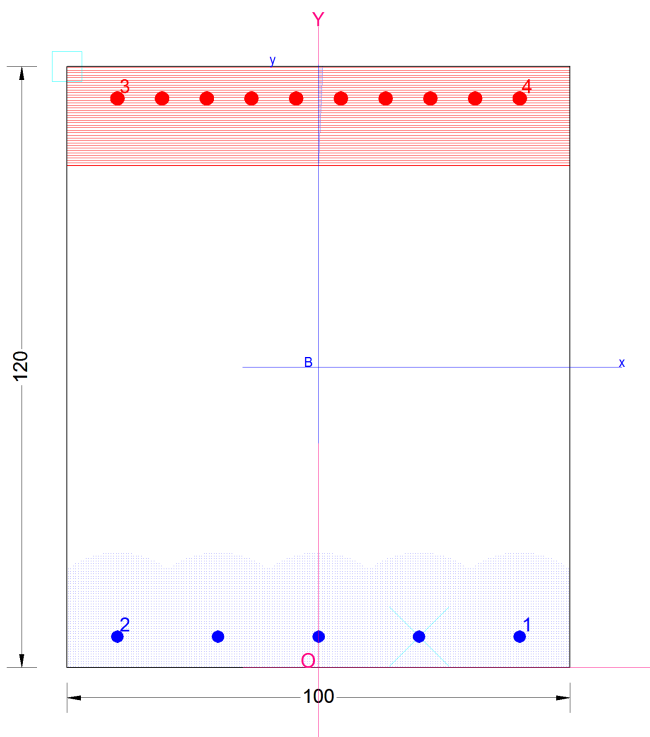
tensioni nel calcestruzzo e nell'acciaio – sezione a-a SLE– muro H= 9.80 m
